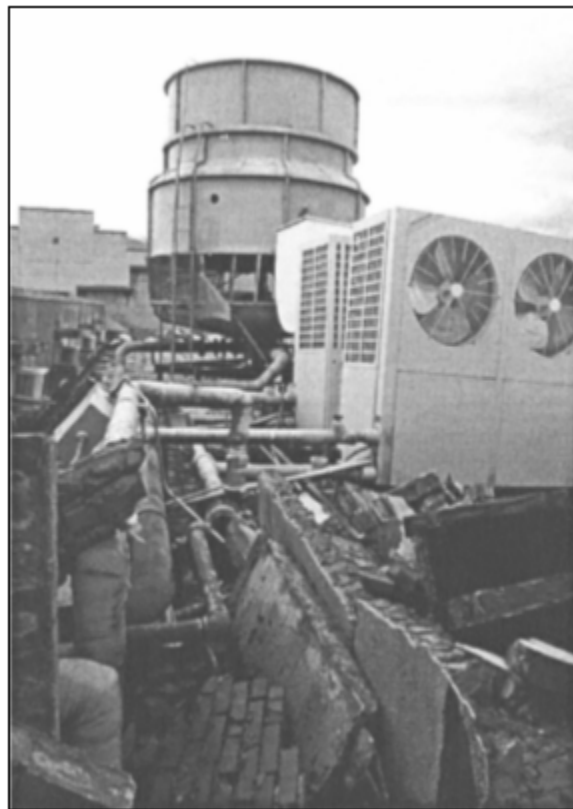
Effondrement d'un mur non porteur isolé lors du tremblement de terre de Jiji à Taiwan
